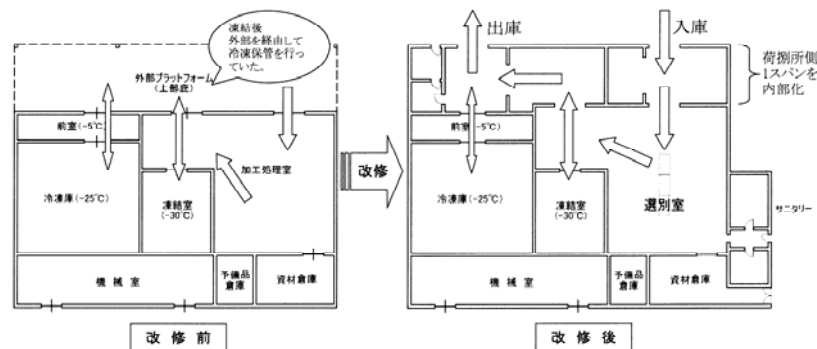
： 冷凍・冷蔵施設棟の改修平面図
